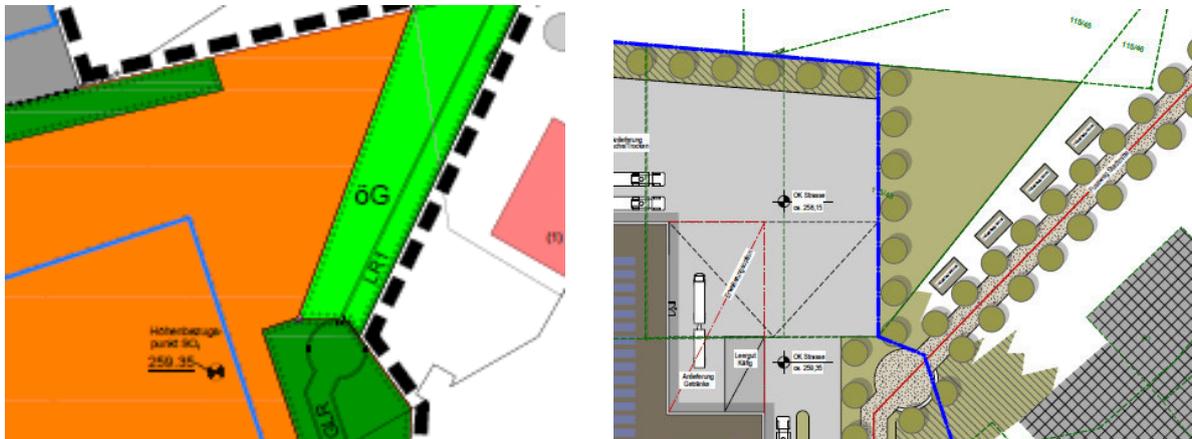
Teilfläche Saarbrücker Straße Nr 14, Flurstücke 115/43 – links Bebauungsplan Entwurf vom 31.10.19 - rechts - Lageplankonzept
